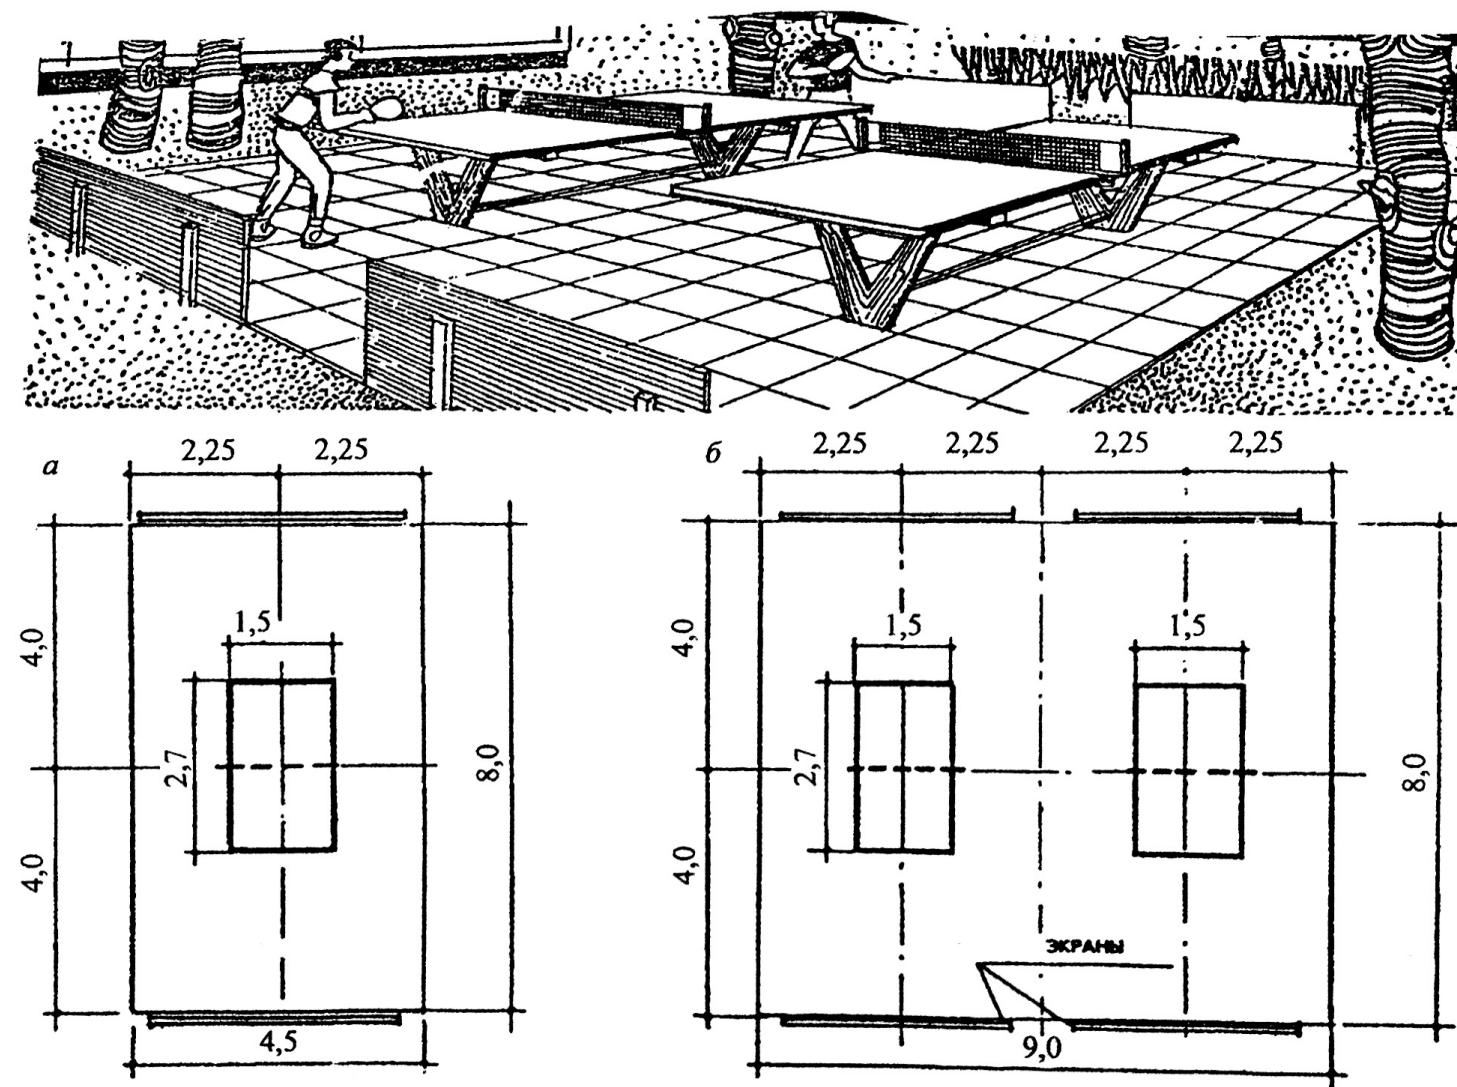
Площадка для настольного тенниса. Планы и размеры площадок для игры в настольный теннис
